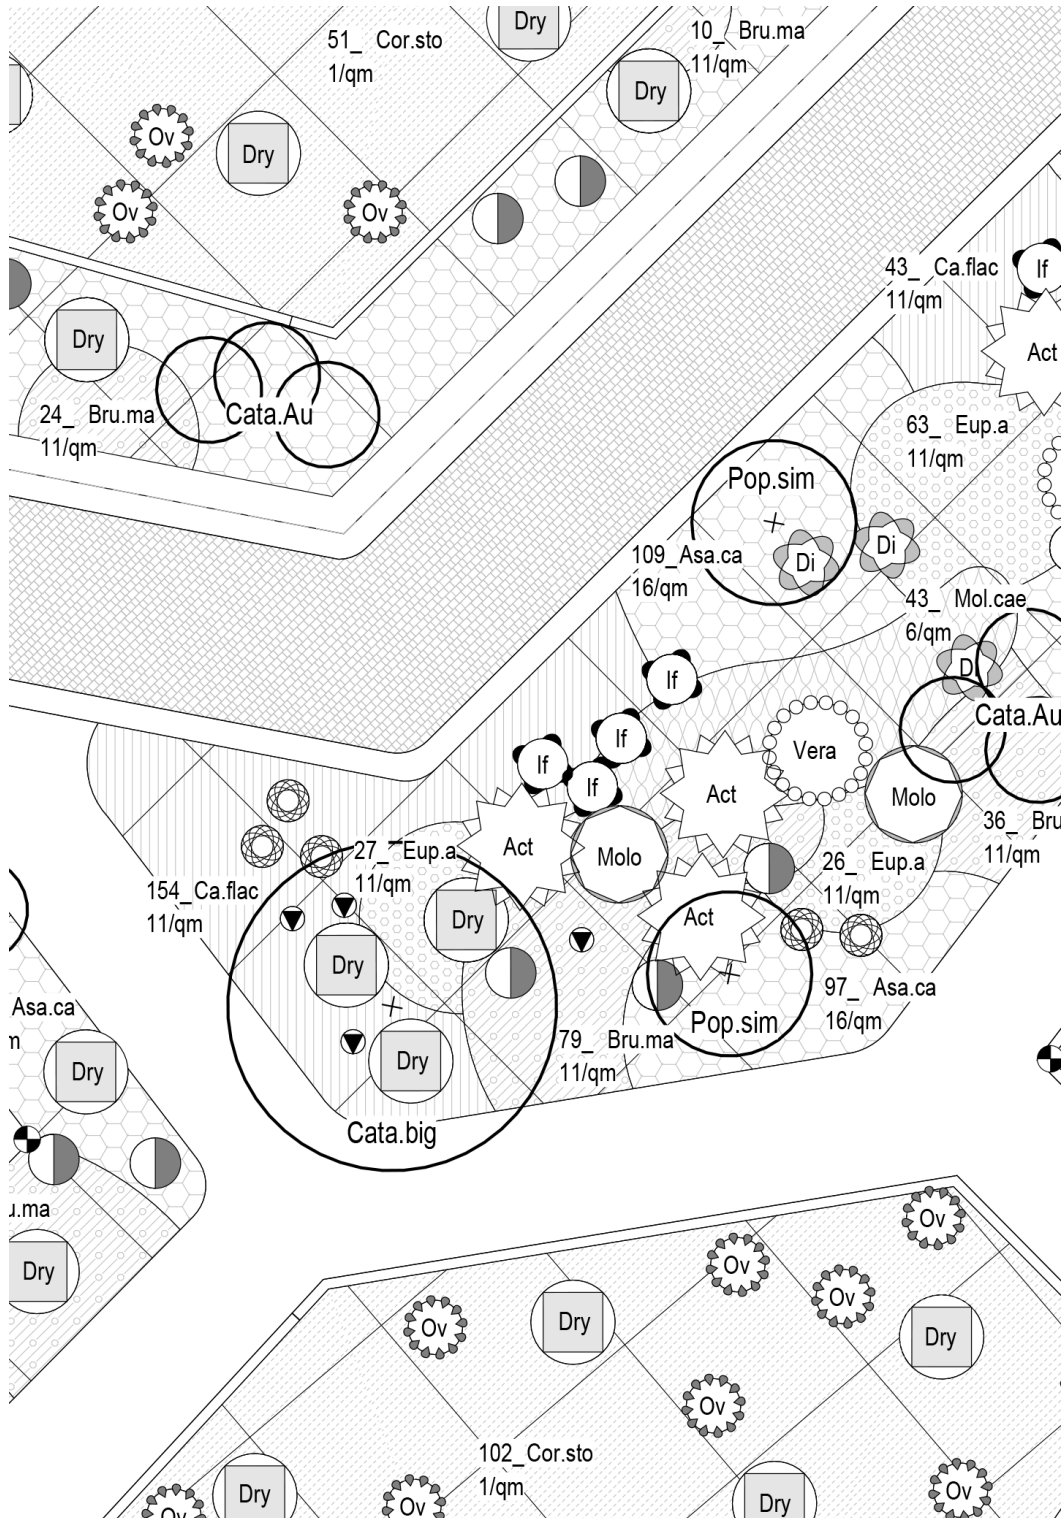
Ausschnitt Bepflanzungsplan (s. Anhang 2)
